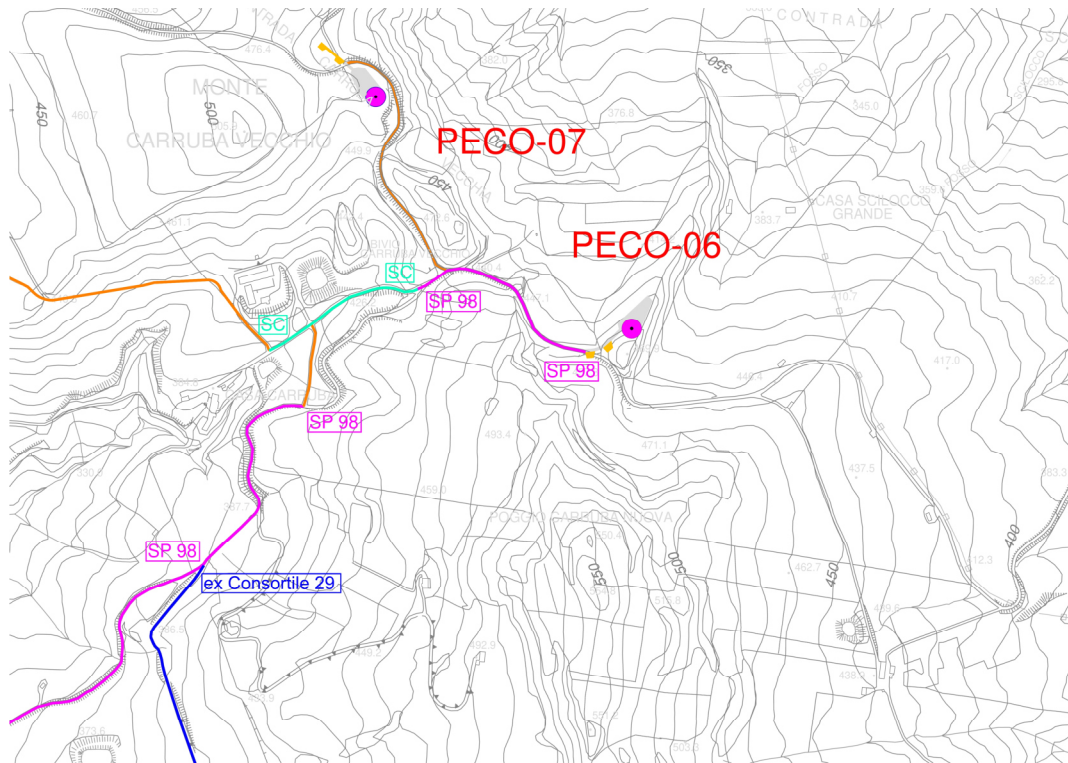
Planimetria delle strade di cantiere scala 1:5.000
